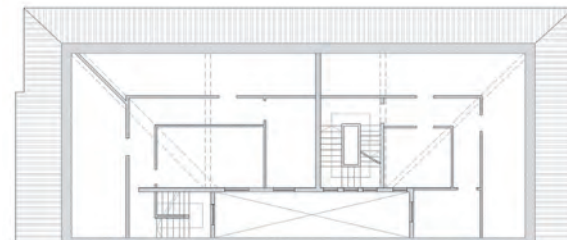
17. PLANTA BAJO CUBIERTA
